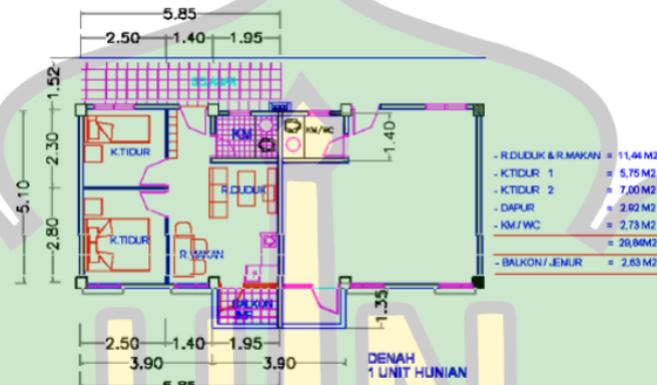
Denah Lantai Tipikal, 1 Lantai 20 Unit Hunian
